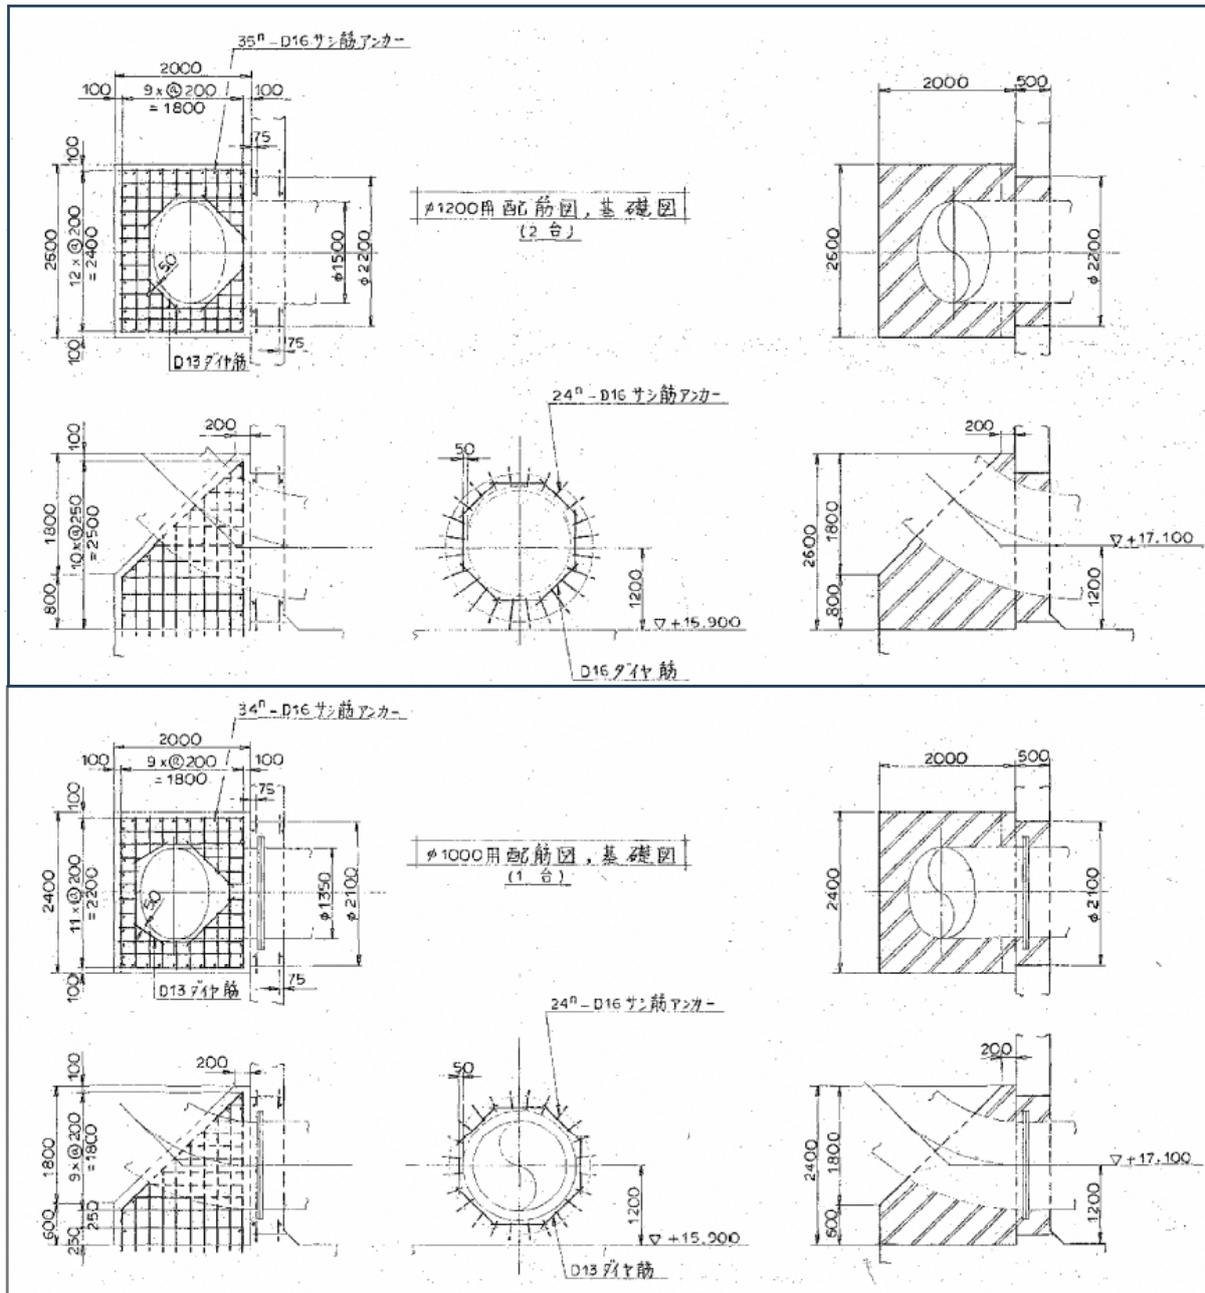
既設吐出槽側コンクリート基礎図 (上図: No. 2~3 ポンプ、下図: No. 1 ポンプ)
